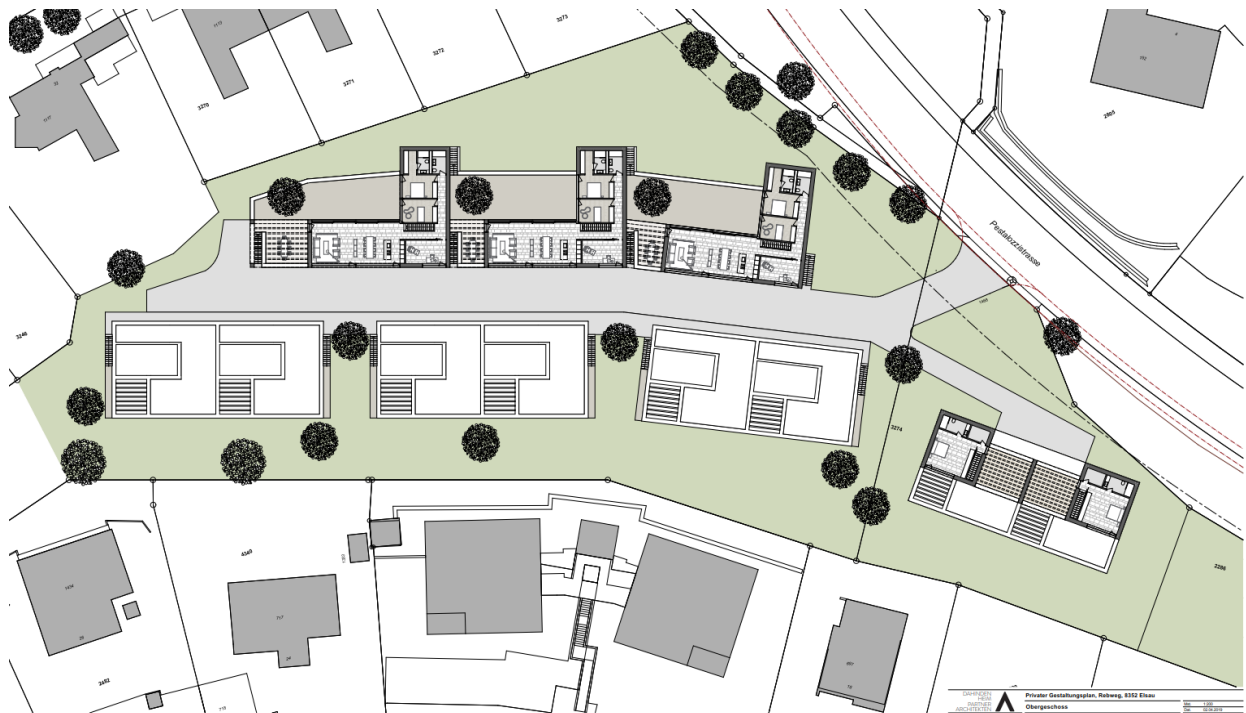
Bebauungskonzept Rebweg, Niveau 1 (Baubereiche A und C, Dachaufsicht Baubereich B)
